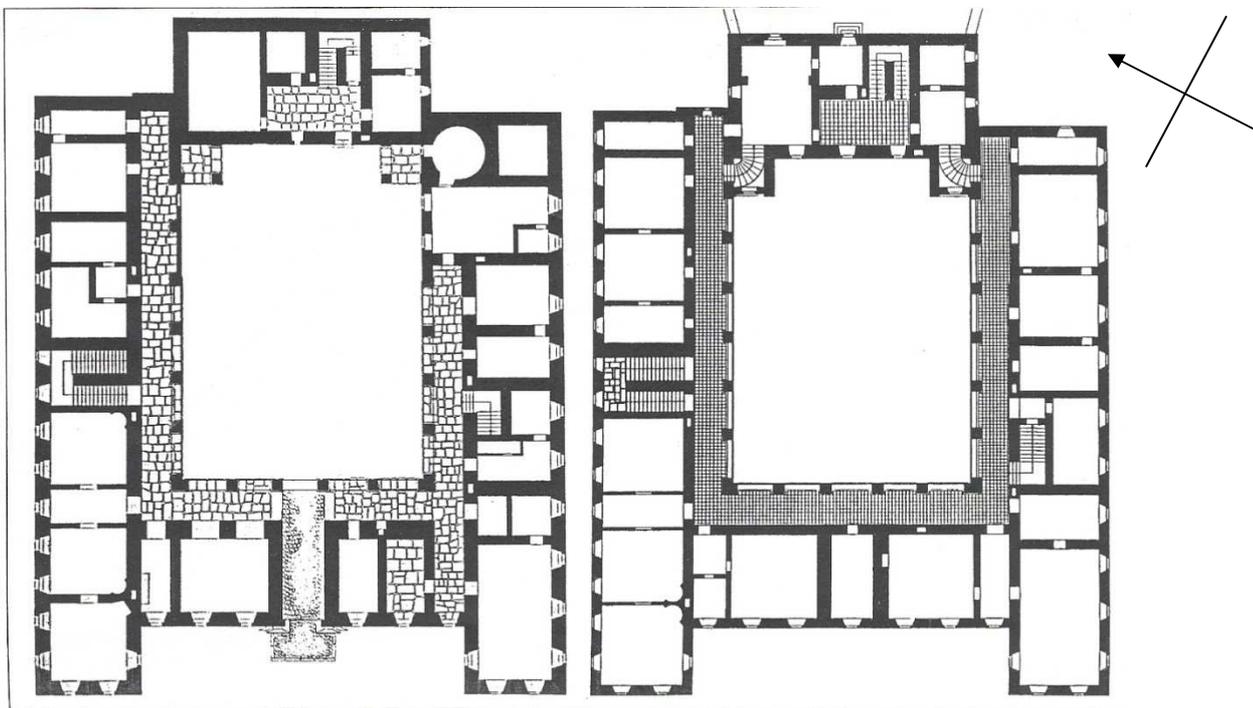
Grundriss Schloss Külm, Erdgeschoß und 1. Obergeschoß
